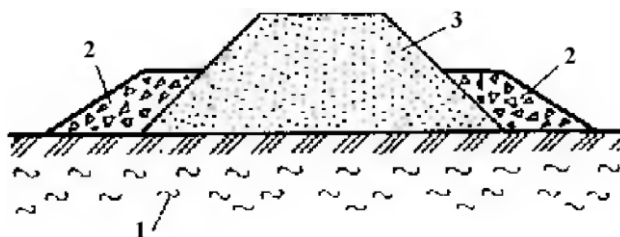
Збільшення стійкості насипу на слабких ґрунтах методом бічної пригрузки: 1 – слабкий ґрунт; 2 – бічна пригрузка; 3 – насип
